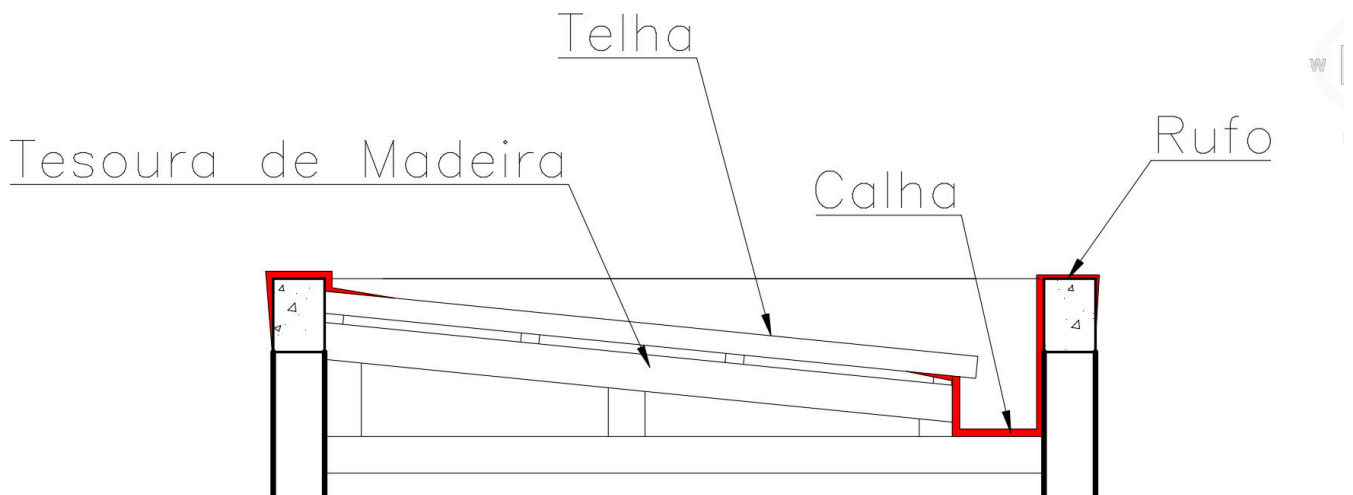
Corte Esquemático sugestão de sistema de cobertura com telhado
